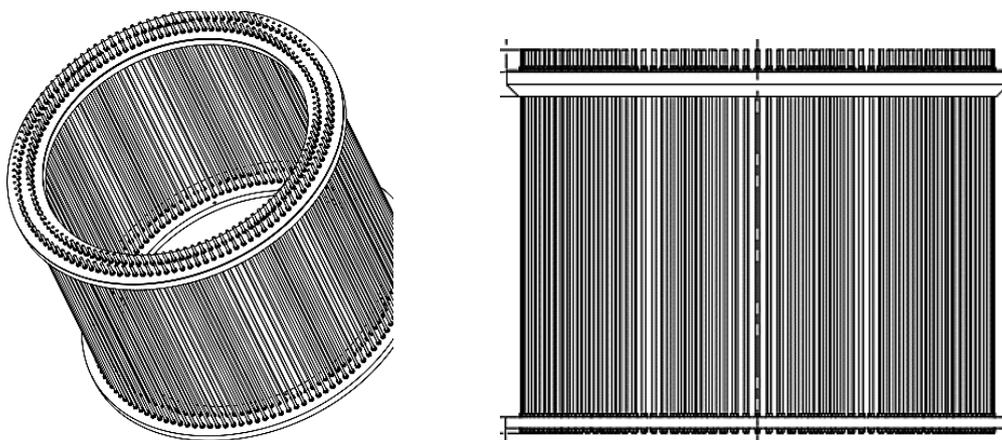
e 16 – Gaiola de parafusos (conexão entre fundação e a torre metálica)
